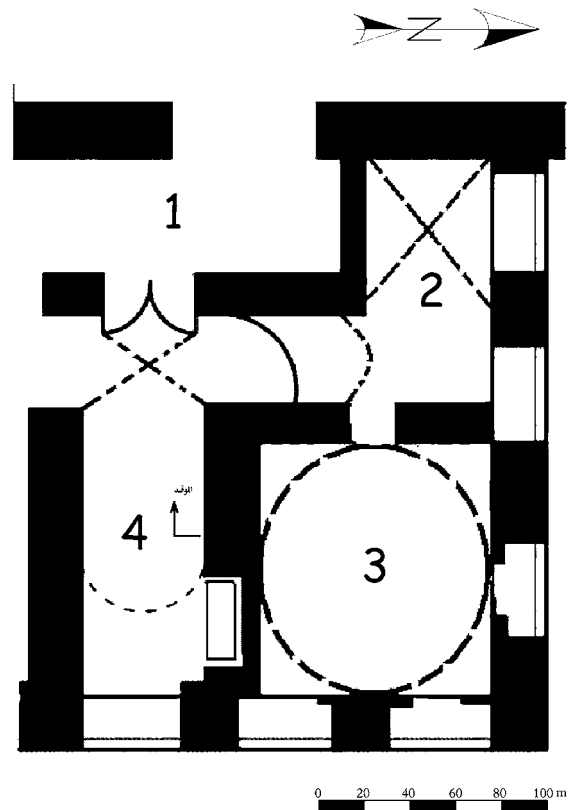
بيت الكعكي: مسقط أفقي للطابق الأرضي ويلاحظ توزيع ومواقع وحدات الحمامين. (عمل بمعرفة الباحث).
